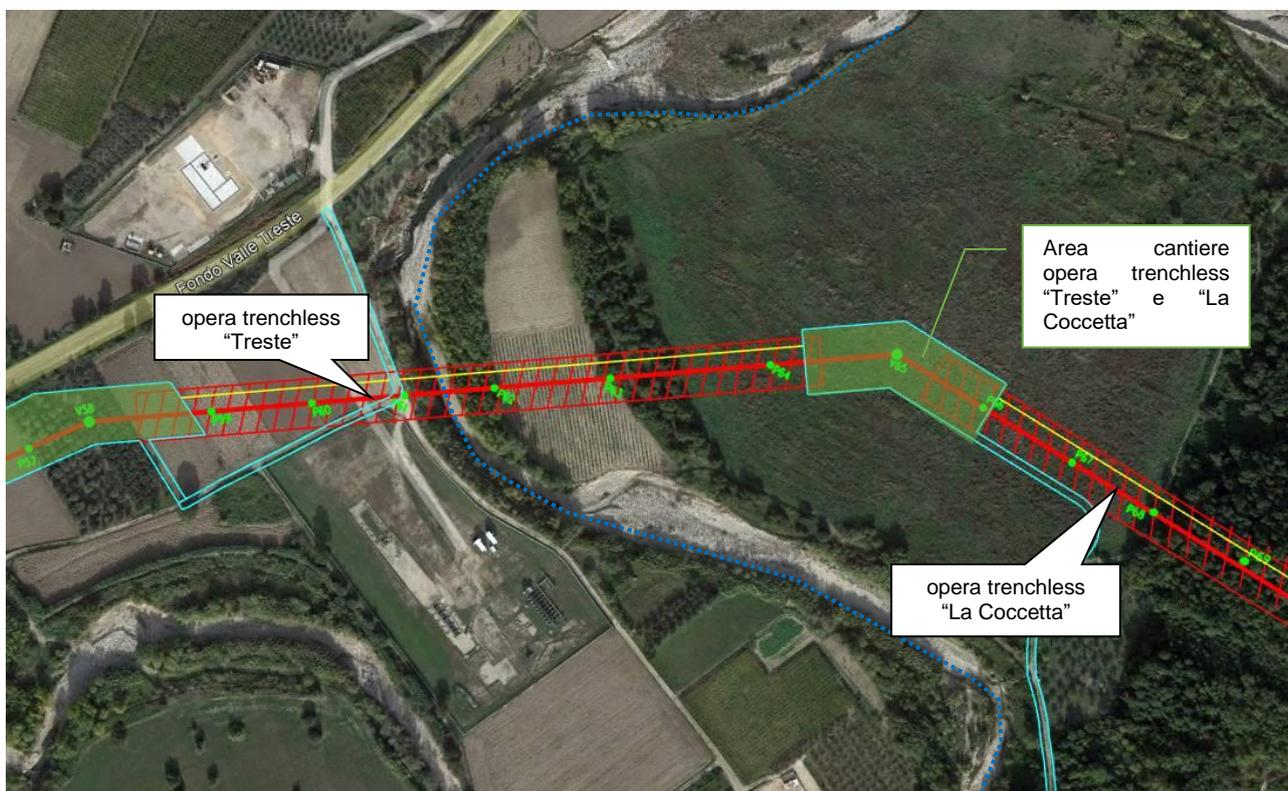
Stralcio satellitare con tracciato di progetto ed individuazione dell'area di cantiere opera trenchless "Treste" e "La Coccetta".
